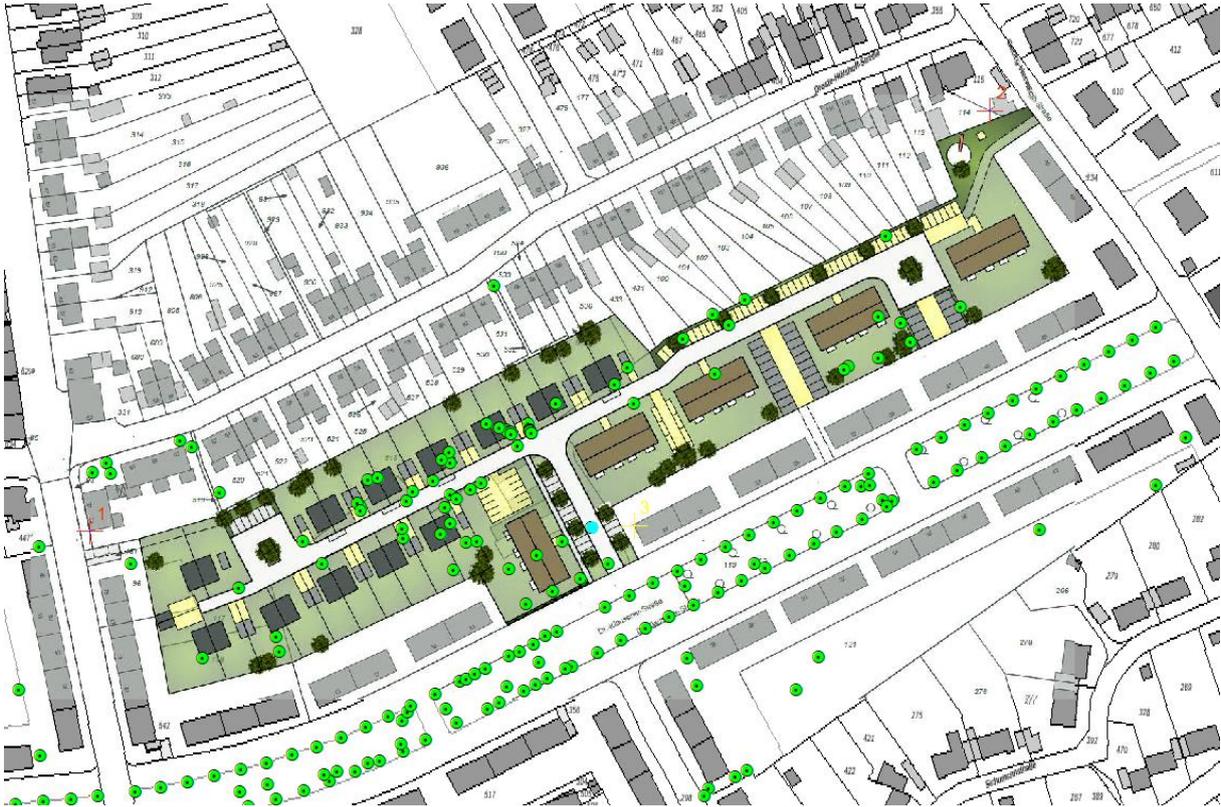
Städtebaulicher Vorentwurf (Stand 23.10.2019) mit Überlagerung der (meisten) Bestandsbäume
